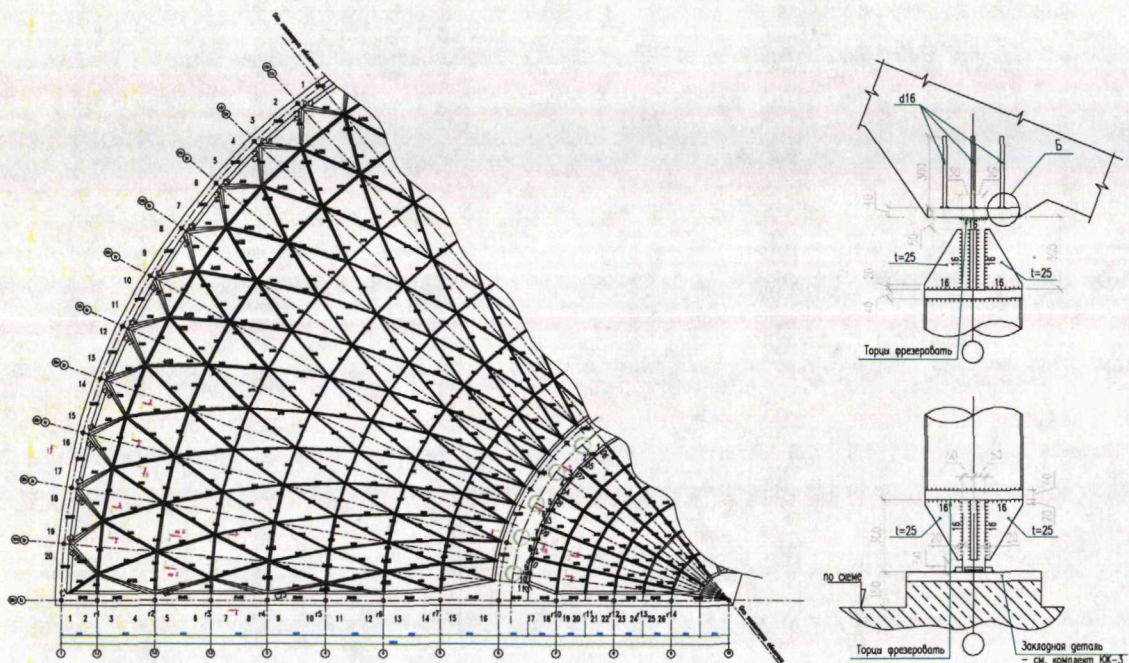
План и схемы исследуемых узлов конструкций
